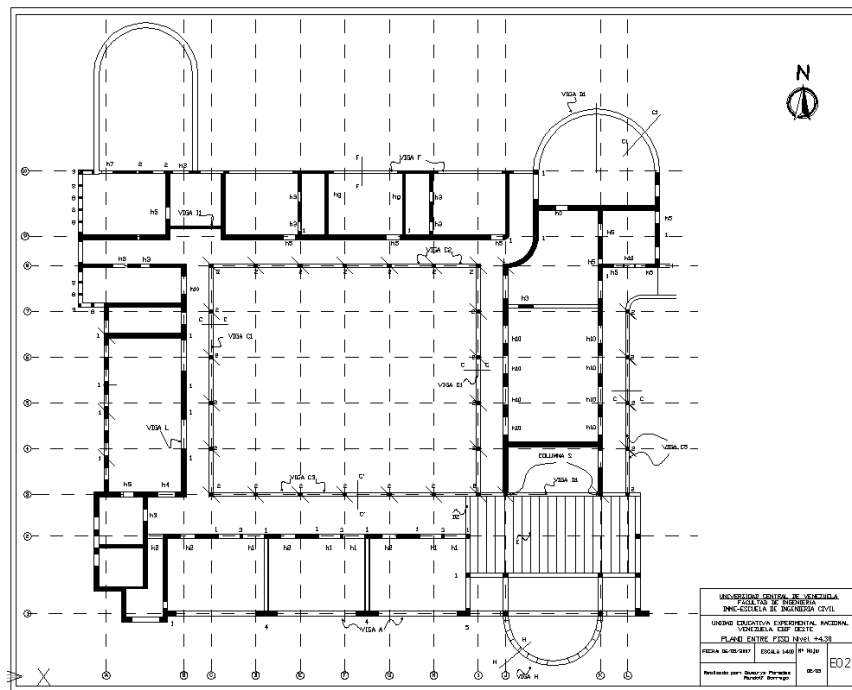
Plano digital de estructura de la planta baja del edificio oeste 4.12.4 Evaluación Sismorresistente
